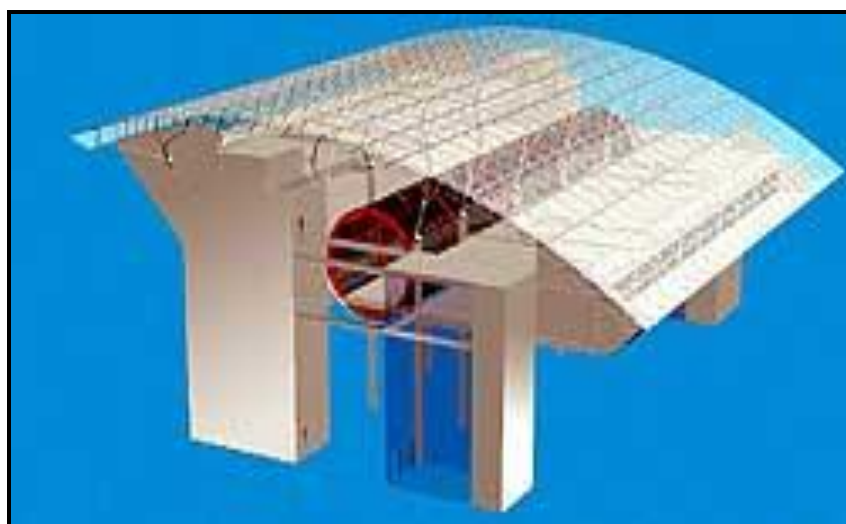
Detalhe da estrutura do Túnel - Prédio Central
